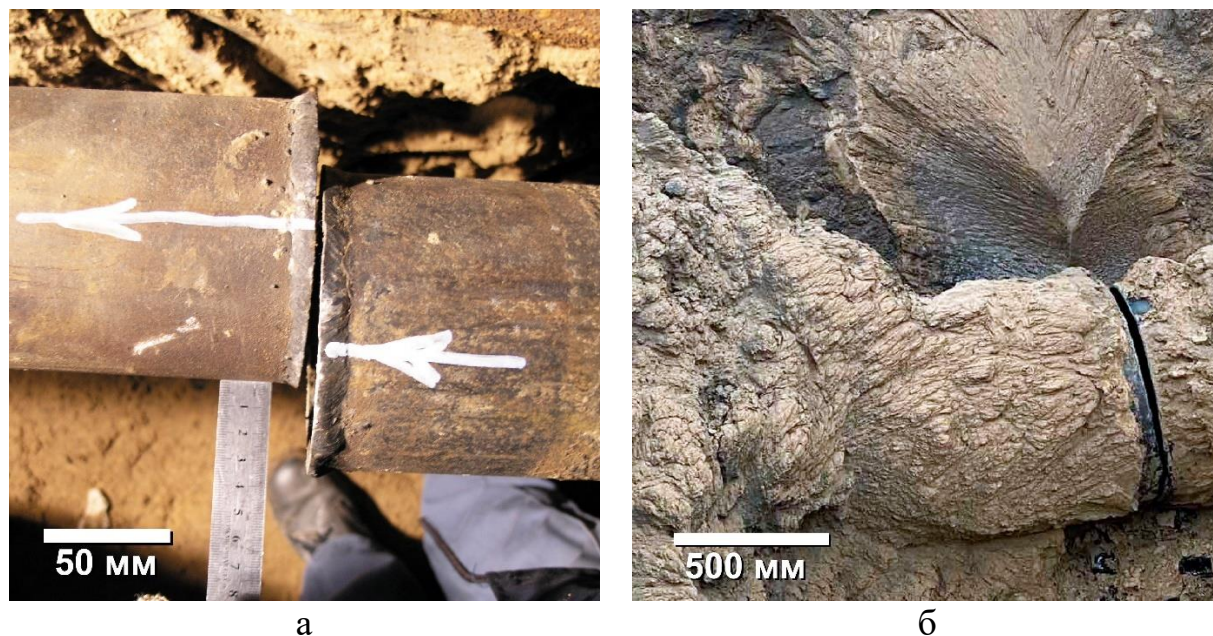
Примеры разрушения трубопроводов при воздействии растягивающих нагрузок (а – разрыв шириной 5мм трубы DN100 по сварному соединению со смещением; б – разрыв шириной 30мм трубы DN700 по основному металлу)
